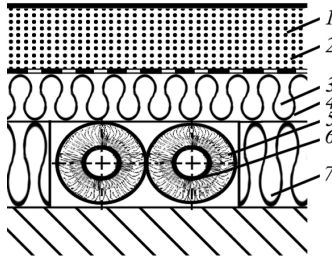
Укладання труб без теплоізоляції на перекриттях між житловими приміщеннями:
